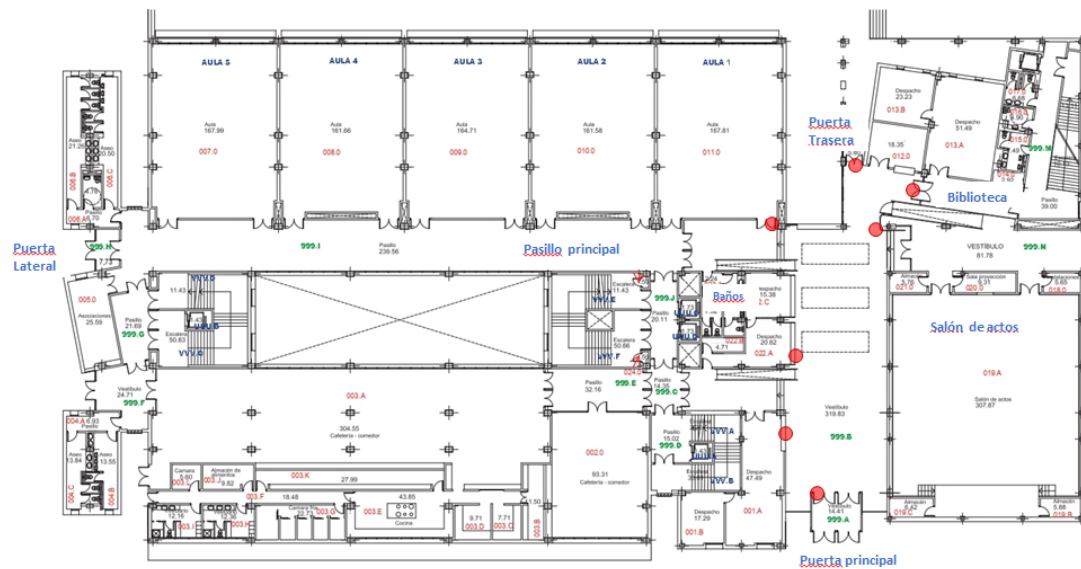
Mapa de la planta baja de la Facultad de Informática con la ubicación definitiva de los beacons (rojo) en el hall.
